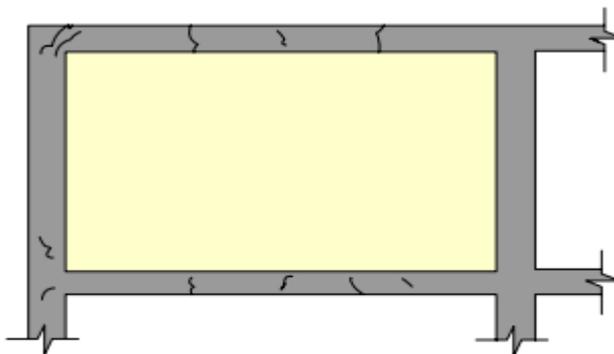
Trincas horizontais, provindos da expansão dos tijolos
